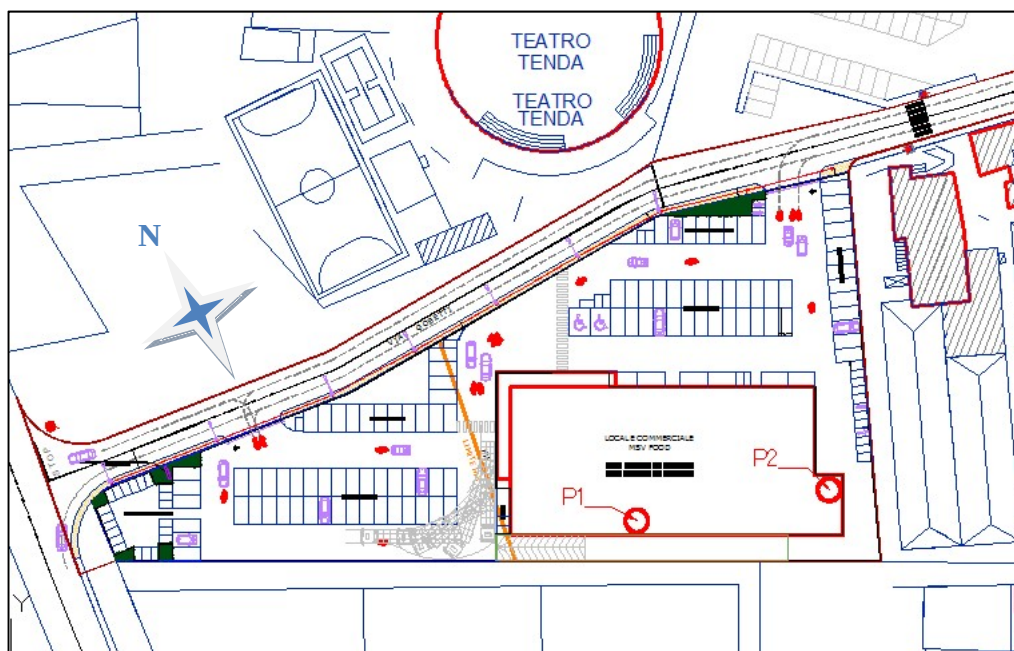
planimetria di progetto ed ubicazione pozzetti esplorativi.
